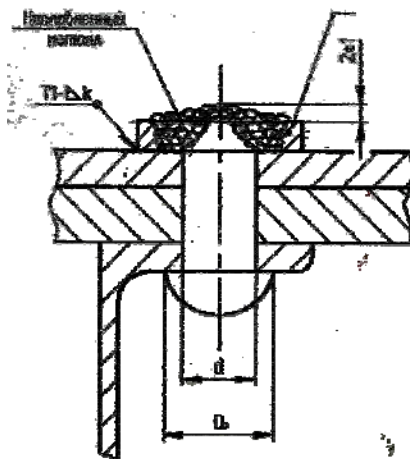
Схема ремонтного восстановления головки заклепки постановкой шайбы
